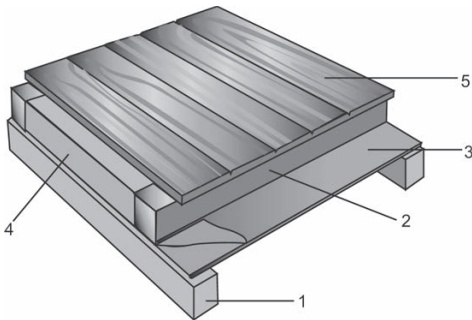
Утепление перекрытия верхнего этажа: 1 — основание; 2 — лаги; 3 — пароизоляция; 4 — минеральная вата; 5 — деревянный настил
